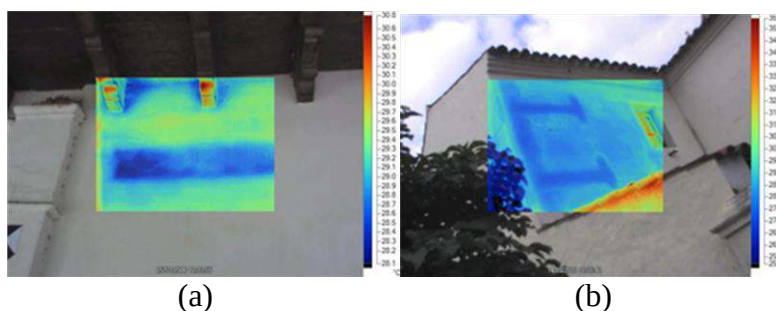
Termografías en donde se aprecian los refuerzos estructurales.
